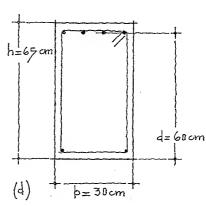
Corte transver\_ sal 4-4, (a).
